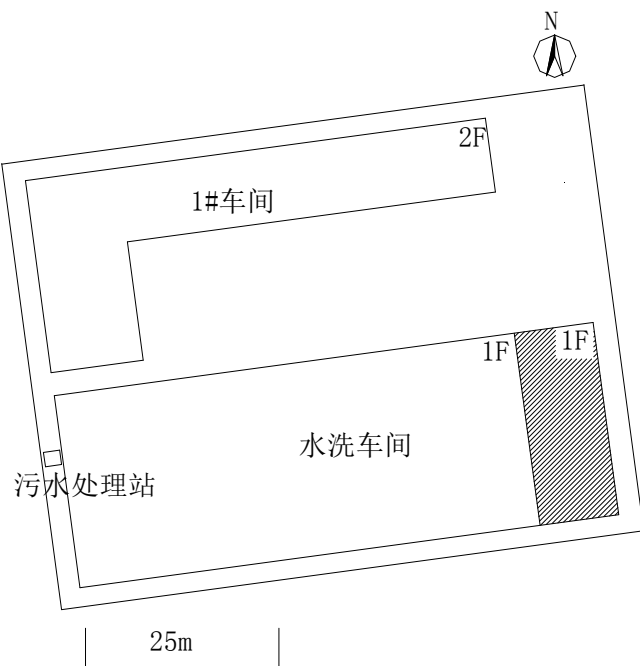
平面布置图 注:斜线部分不属于本项目
